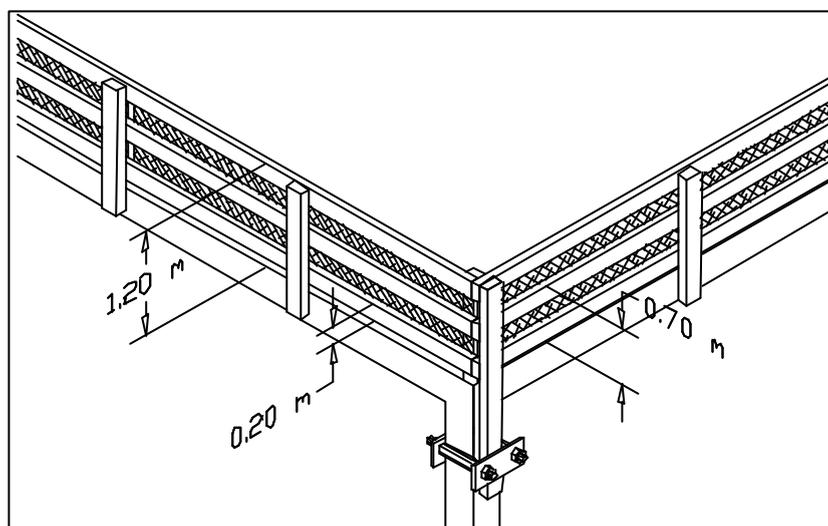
GcR combinado com estrutura metálica, com montantes fixadas por meio de parafuso
